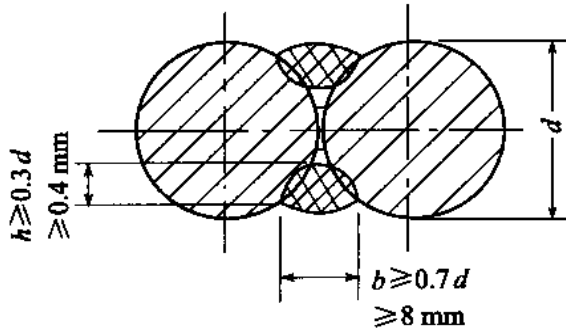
1 钢筋搭接、帮条焊接的焊缝
